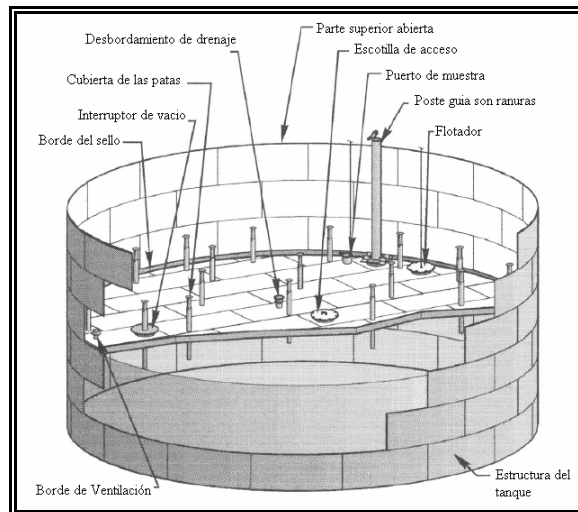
Tanque Techo Flotante Externo tipo doble cubierta
